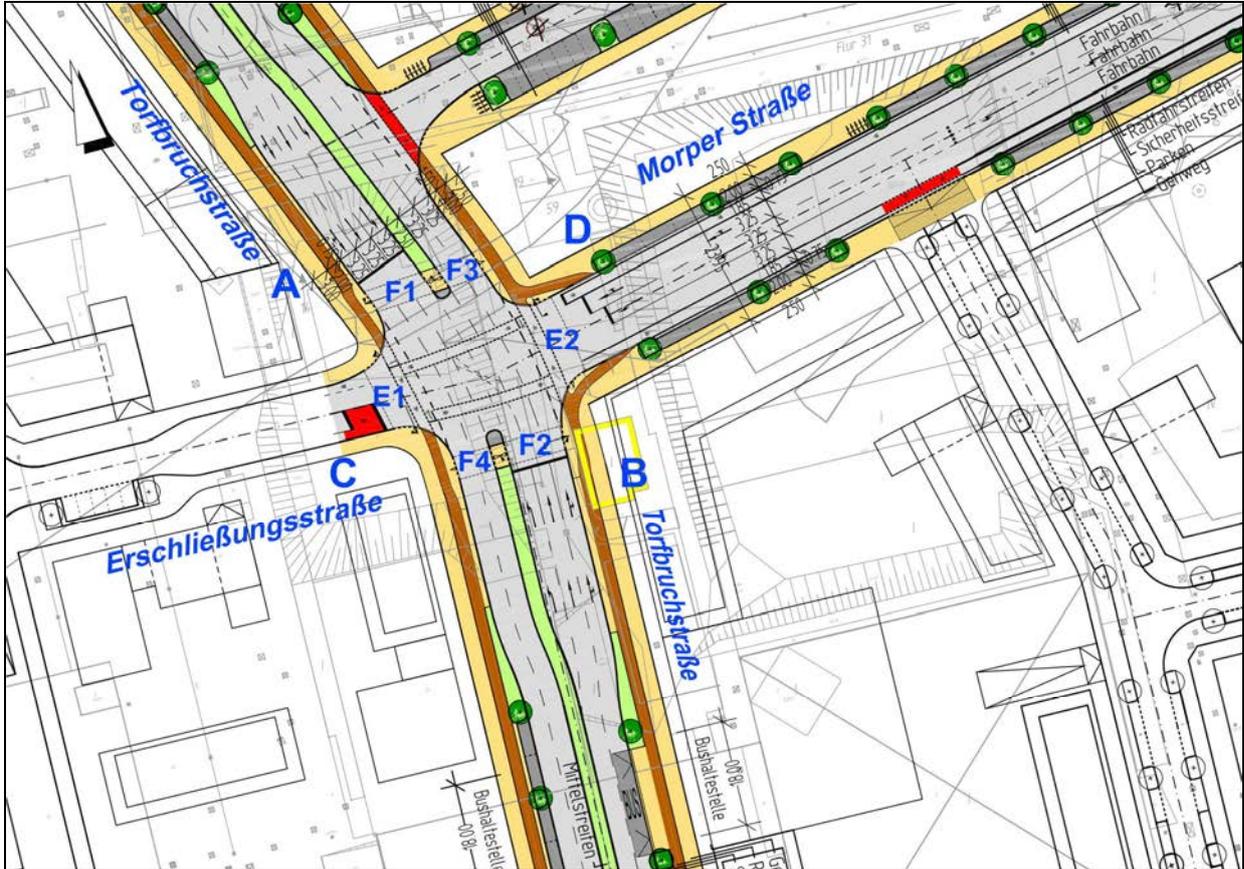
Knotenpunkt Torbruchstr./Morper Str./Erschließungsstr. (Planstraße 9)
